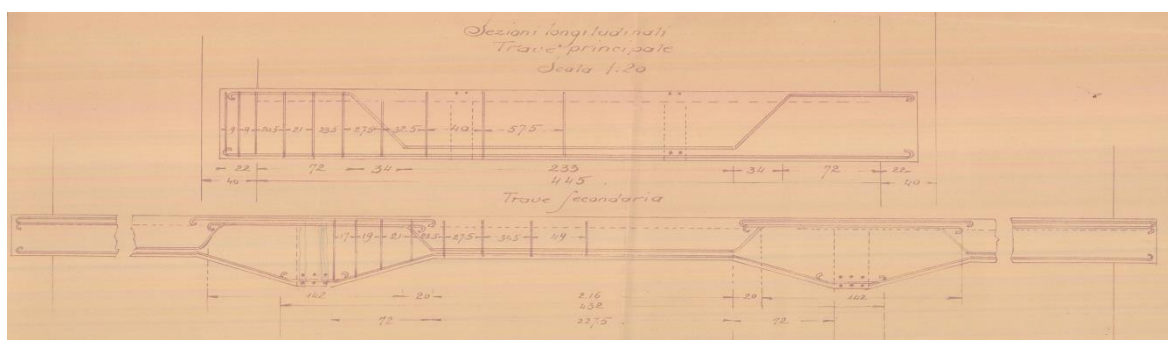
Sezione longitudinale delle precedenti travi del corpo D
